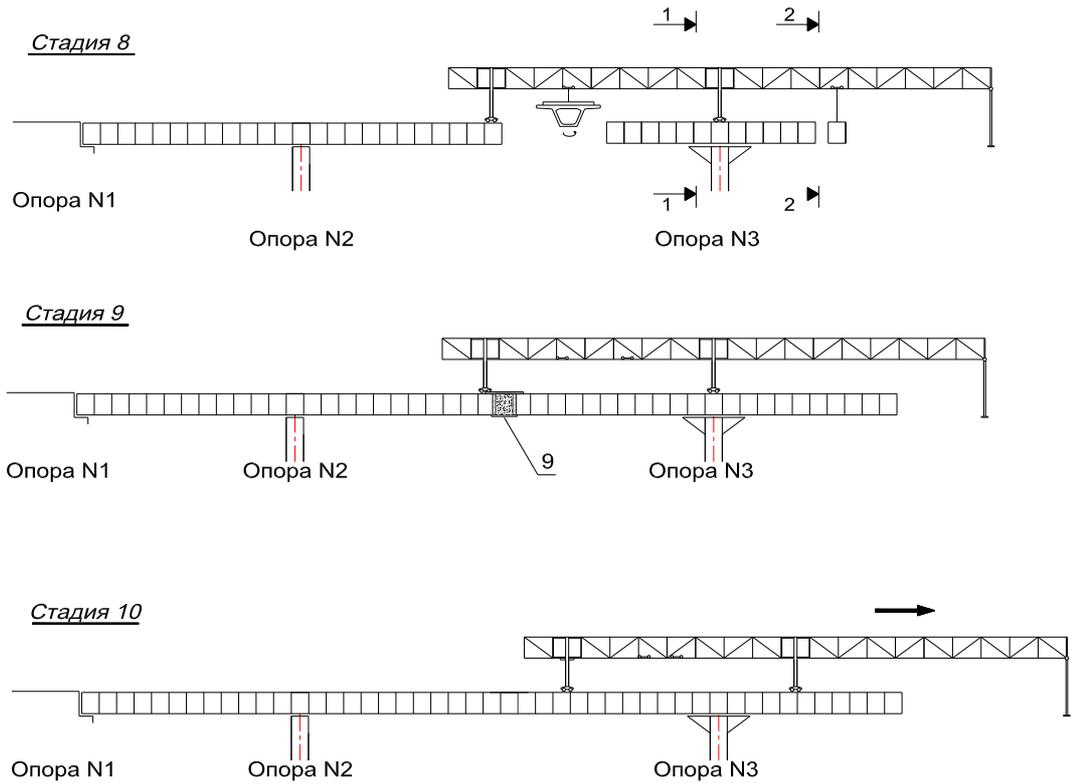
Монтаж составных железобетонных пролетных строений агрегатом шлюзового типа (продолжение): 9 – монолитный замыкающий блок в середине пролета, бетонированный в опалубке; 10 – грузовая тележка агрегата
